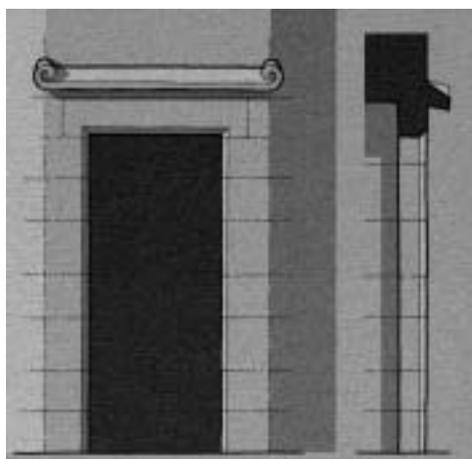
Alzado y sección de la puerta de acceso a la escalera de caracol.
